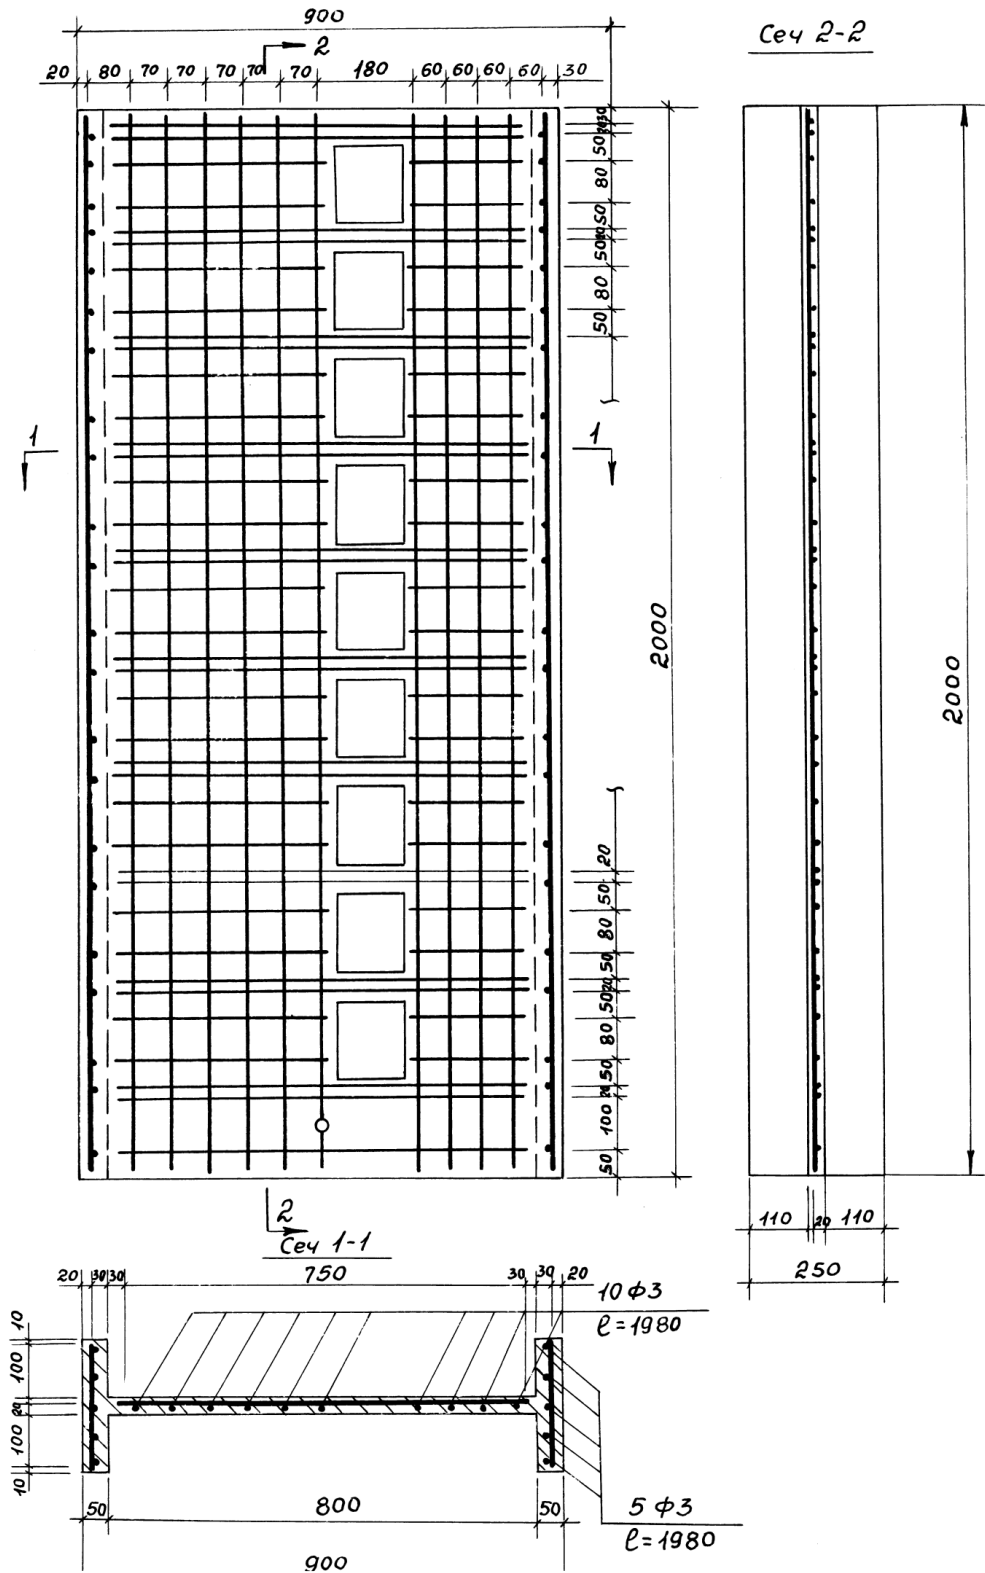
Схема армирования диафрагмы-модели девятиэтажного здания в масштабе 1:15
